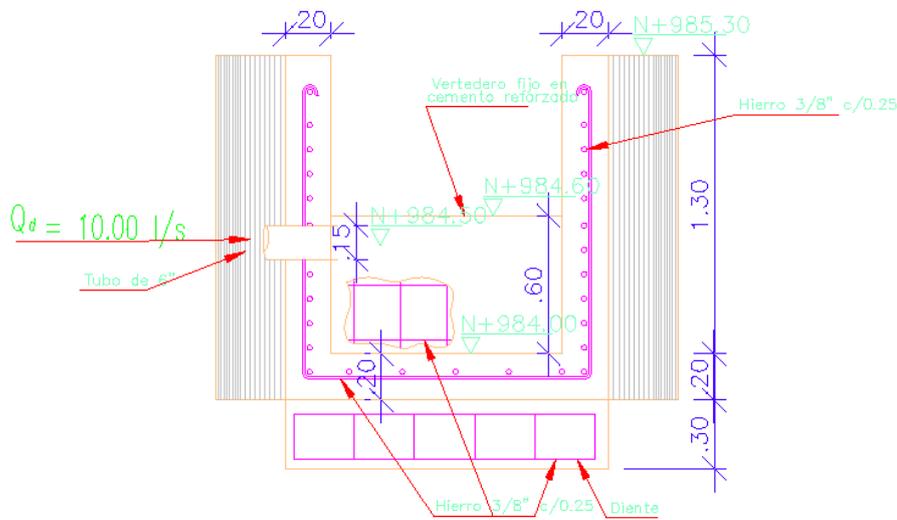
Detalles de la obra de captación, vista en corte longitudinal.
